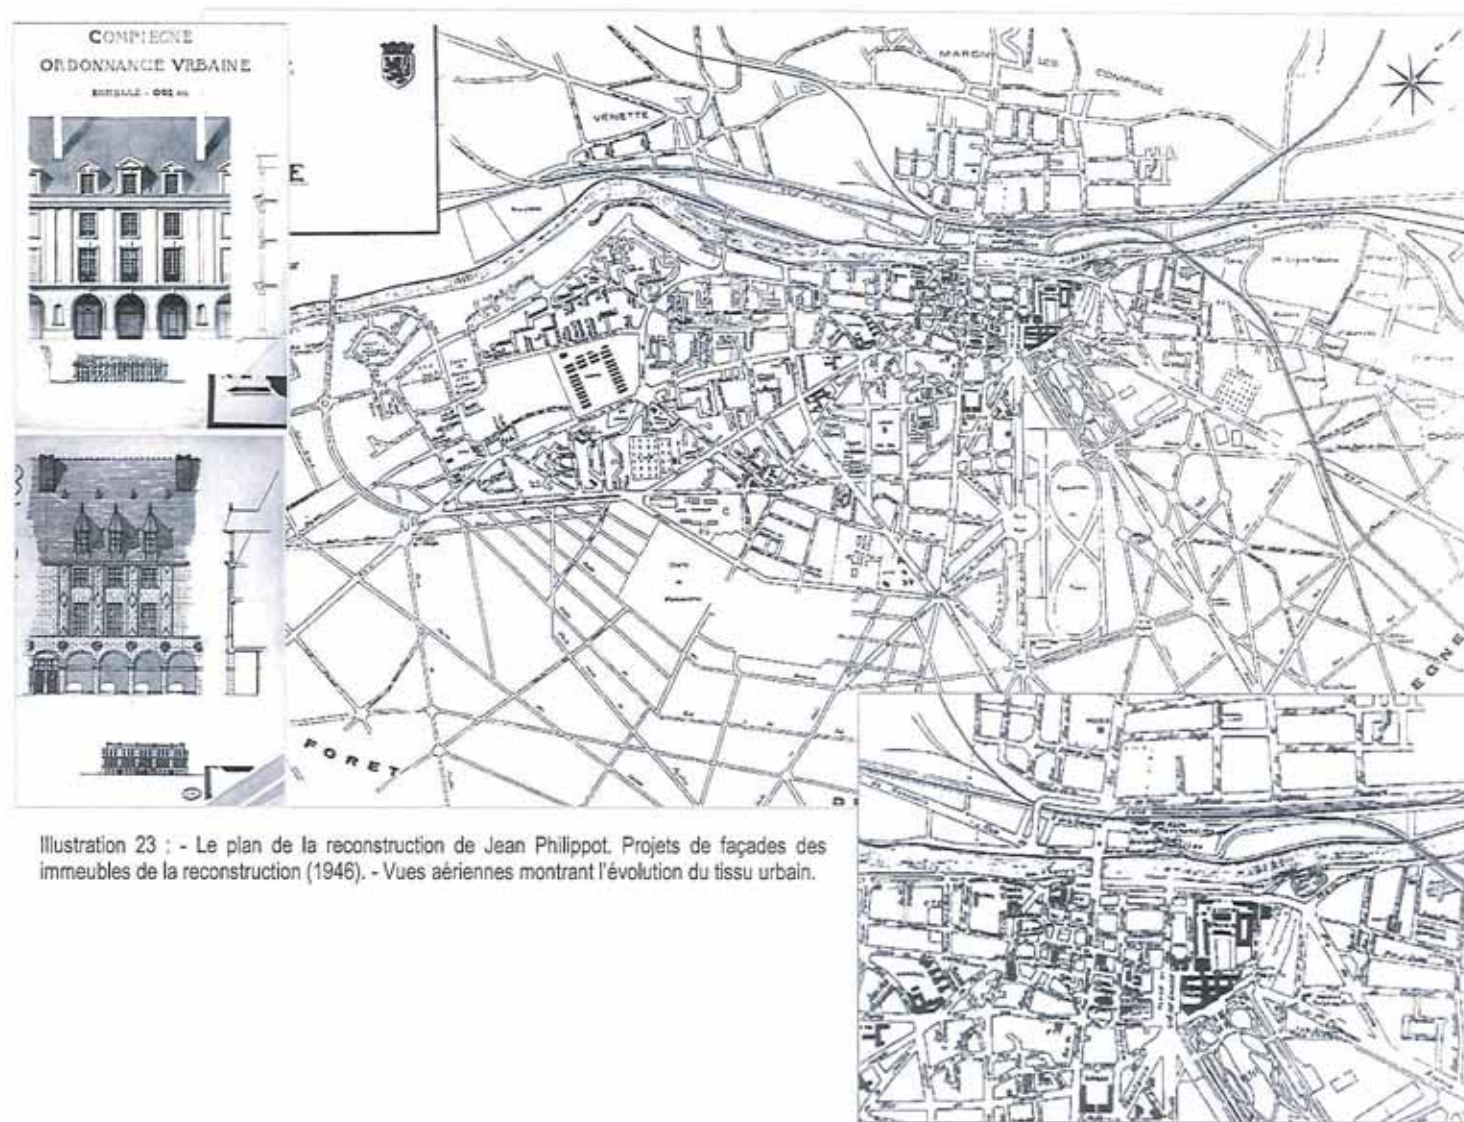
Le plan de la reconstruction de Jean Philippot. Projets de façades des immeubles de la reconstruction (1946). - Vues aériennes montrant l'évolution du tissu urbain.
